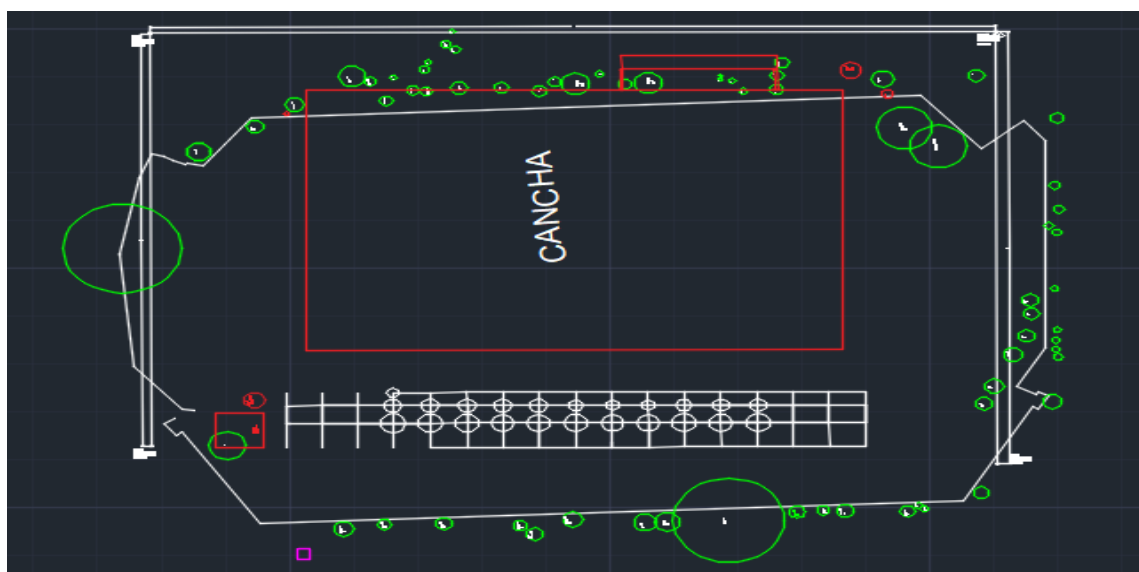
Levantamiento de árboles de la zona trazado en AutoCAD.
